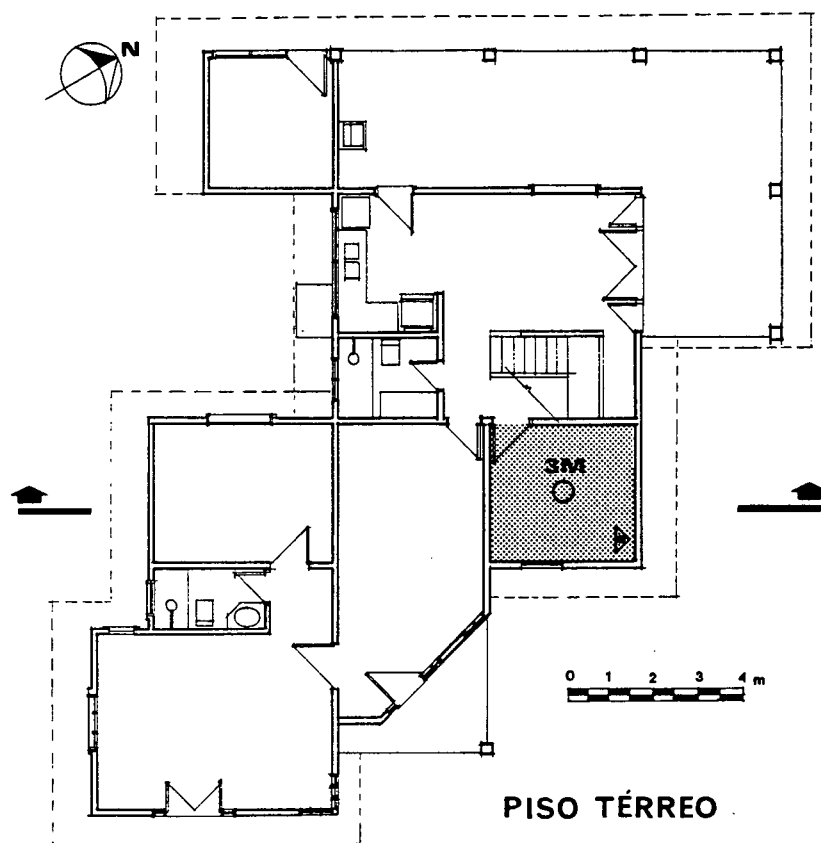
Planta pavimento térreo casa nº3 (Campeche)
